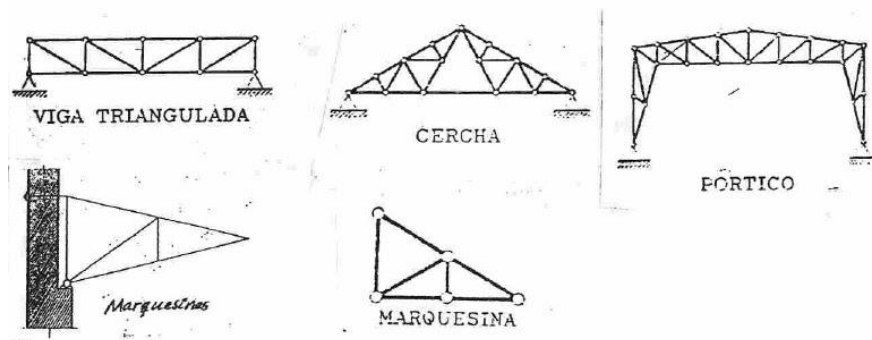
Estructuras trianguladas. Inevid.blogspot.com
